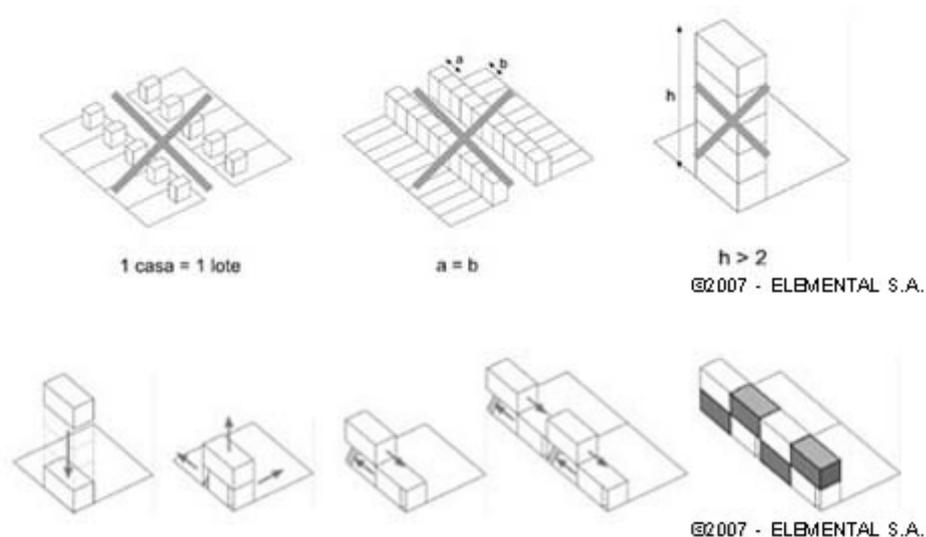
Estratégia de ocupação dos lotes (FONTE: BASULTO, 2009)
